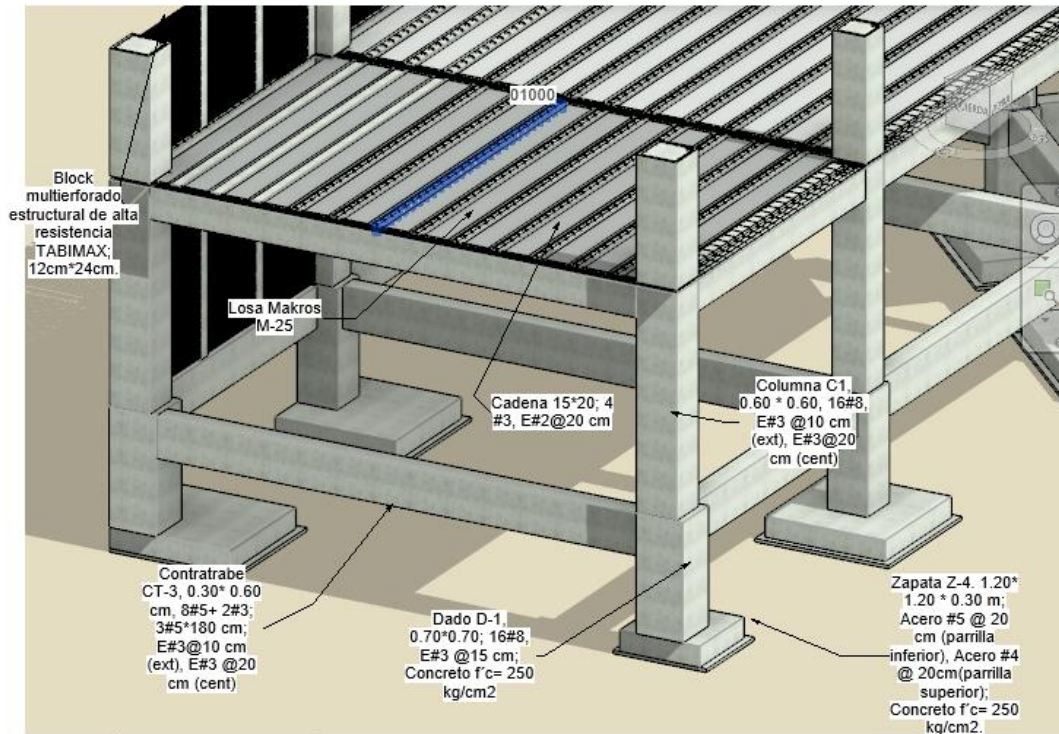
Elementos estructurales, archivo nativo (Autoría propia).
